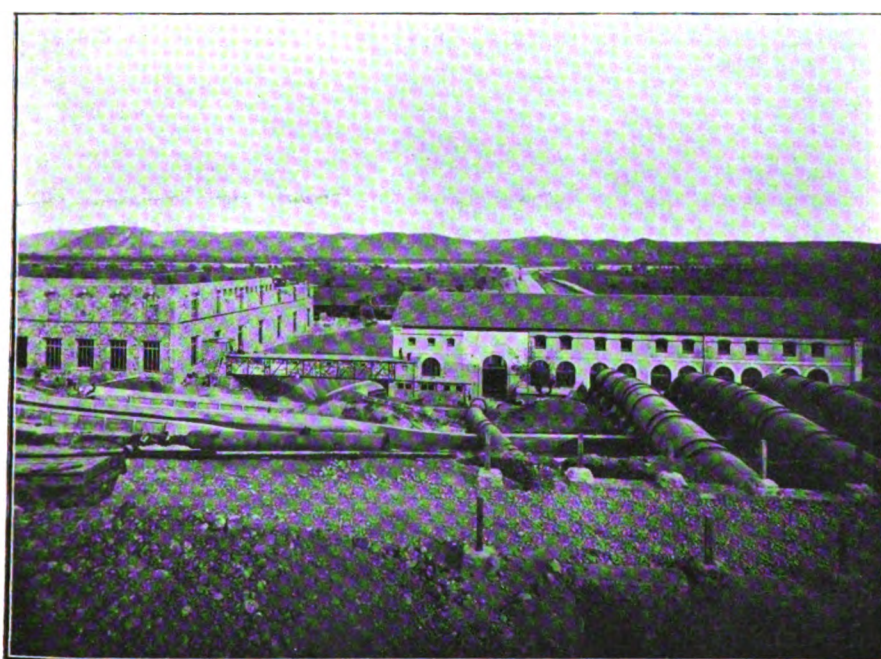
Vue de l'usine génératrice de la Brillanne
